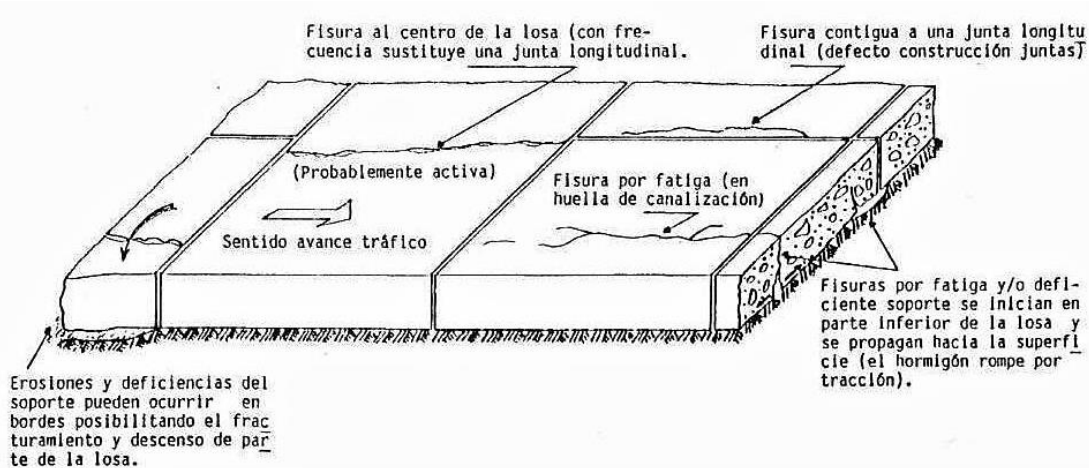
Esquema de fisuración longitudinal en pavimentos rígidos.¹²¹
